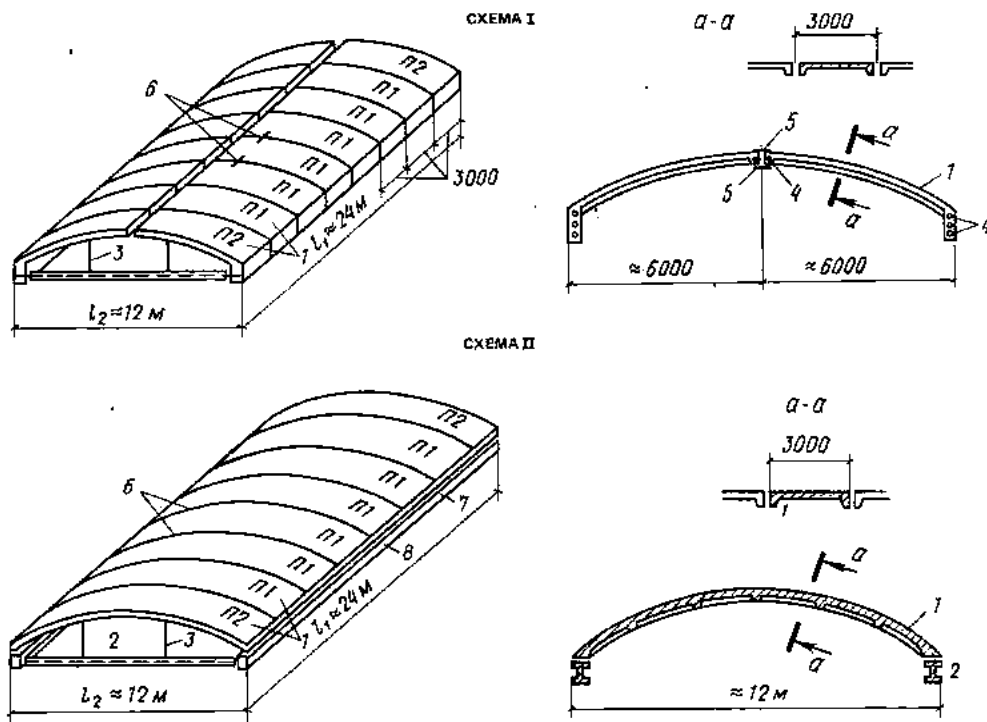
Конструкції збірного покриття з довгими оболонками :
